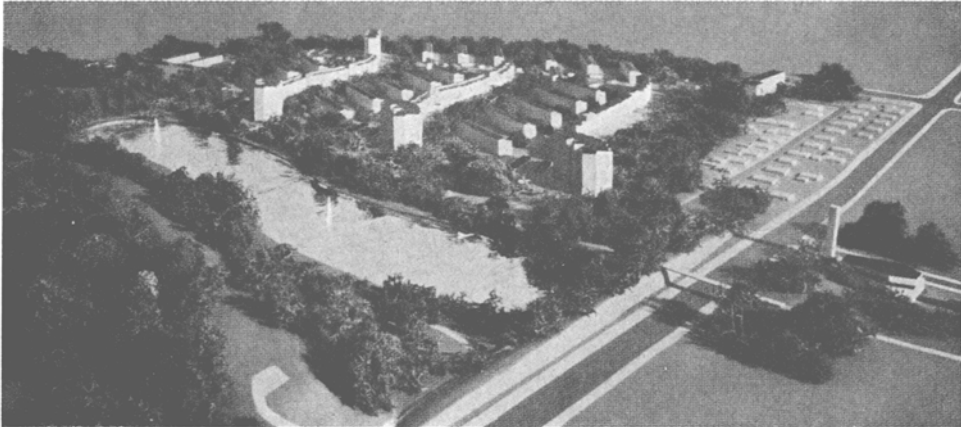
Parkwohnanlage Nürnberg West – nach einer Planung des Verfassers in den Jahren 1960 bis 1966 durchgeführt. – Modell-Ansicht
